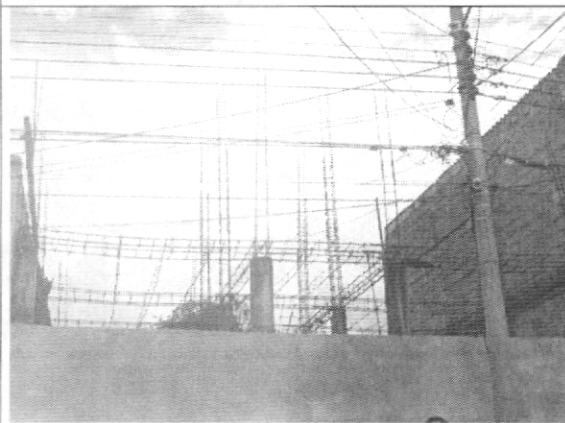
Aceros de refuerzo para la construcción de los elementos estructurales de los pisos superiores
